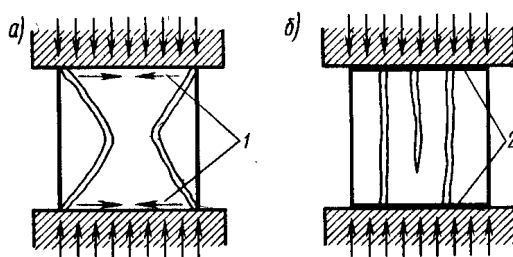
Характер разрушения бетонных кубов при сжатии: 1 – силы трения; 2 – смазка
